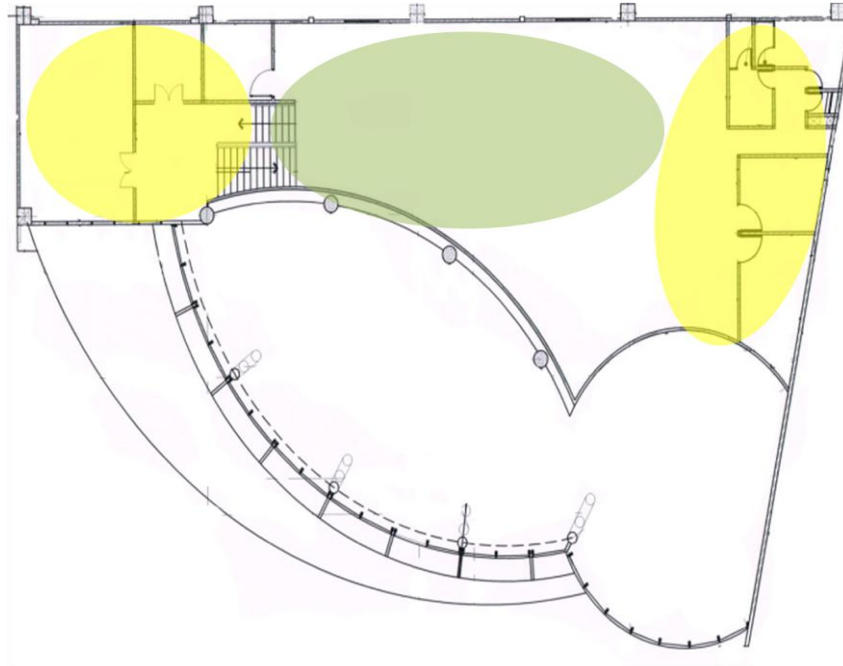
Zoning dan Grouping Alternatif 3 Lantai 2
